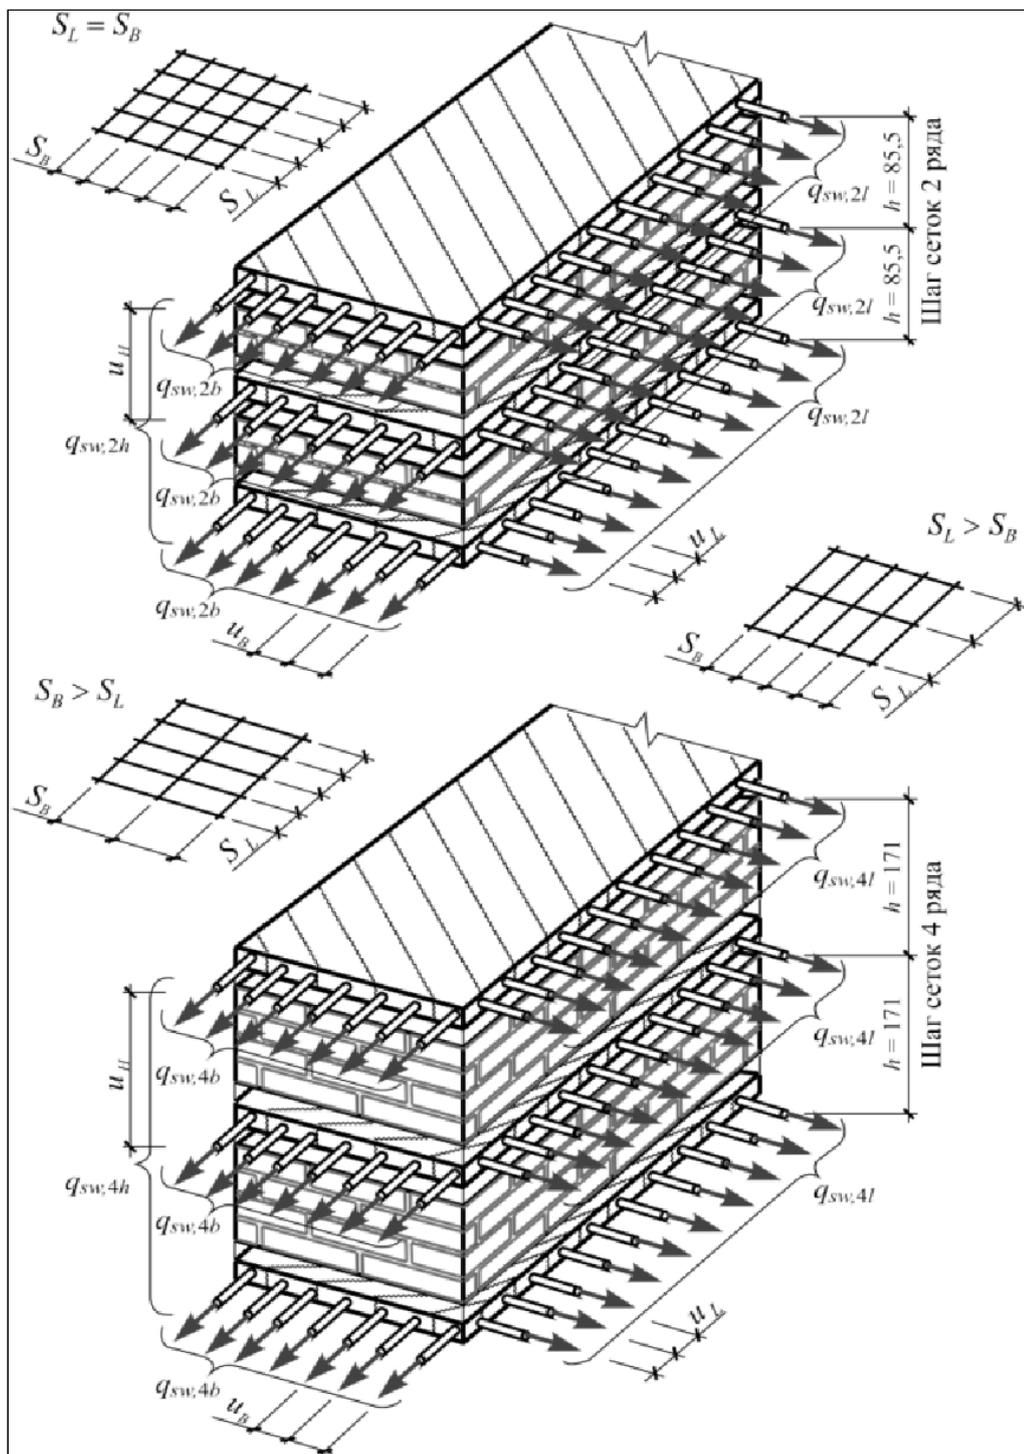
Схемы армирования, характер распределения усилий в арматурных стержнях и виды сеток для армирования стен
